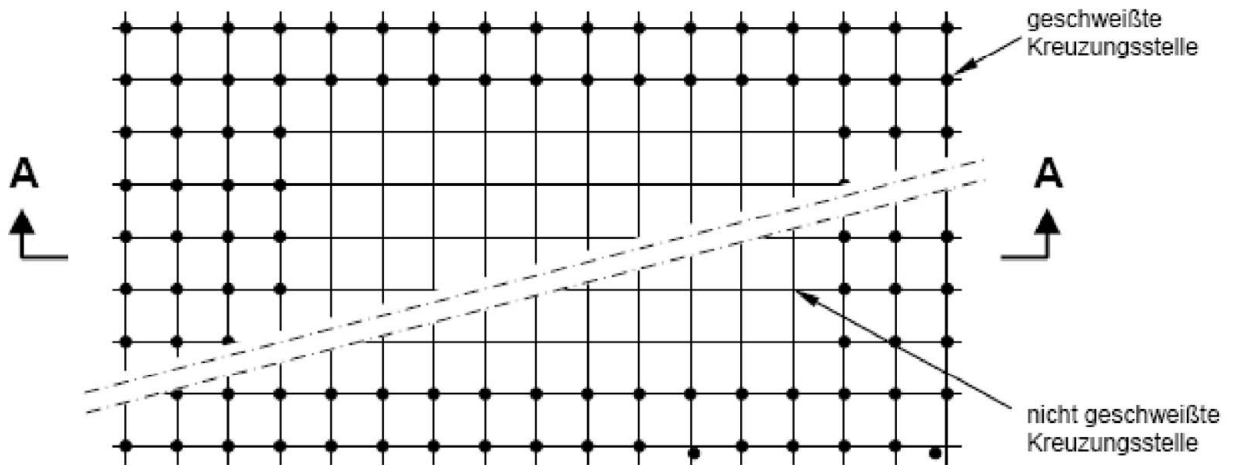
Zulässige Bereiche der Schweißung (hier als Beispiel dargestellt für nicht gestaffelte Bewehrung)
